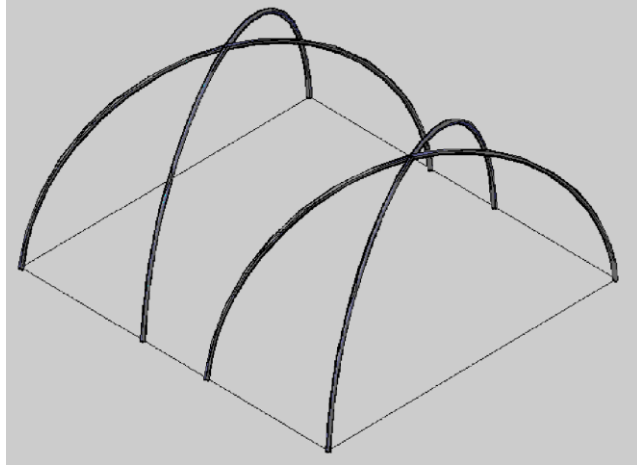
Perspectiva dos pórticos de estabilização bidirecionais
